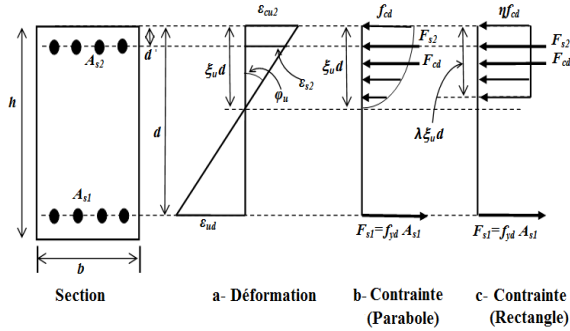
Comportement de la section d'une poutre à l'état limite ultime.
